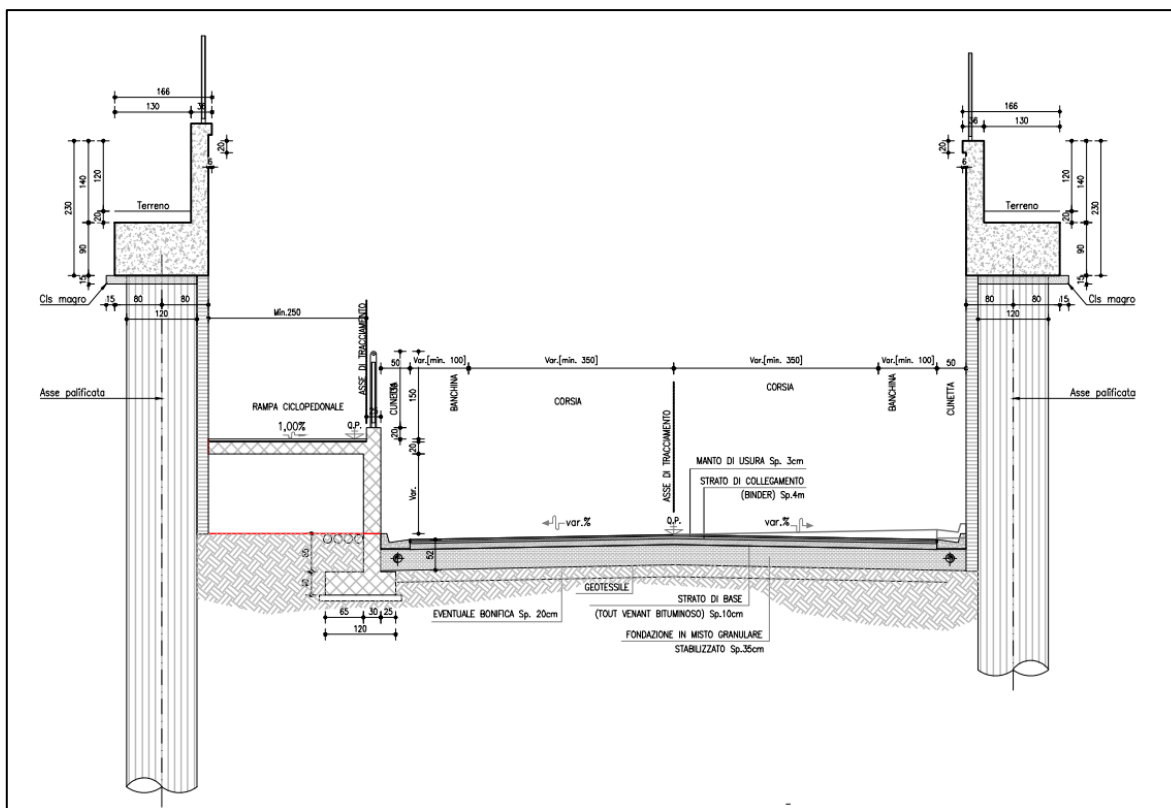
Sezione tipo asse principale con pista ciclopedonale e palificata (sezione a cielo aperto)
